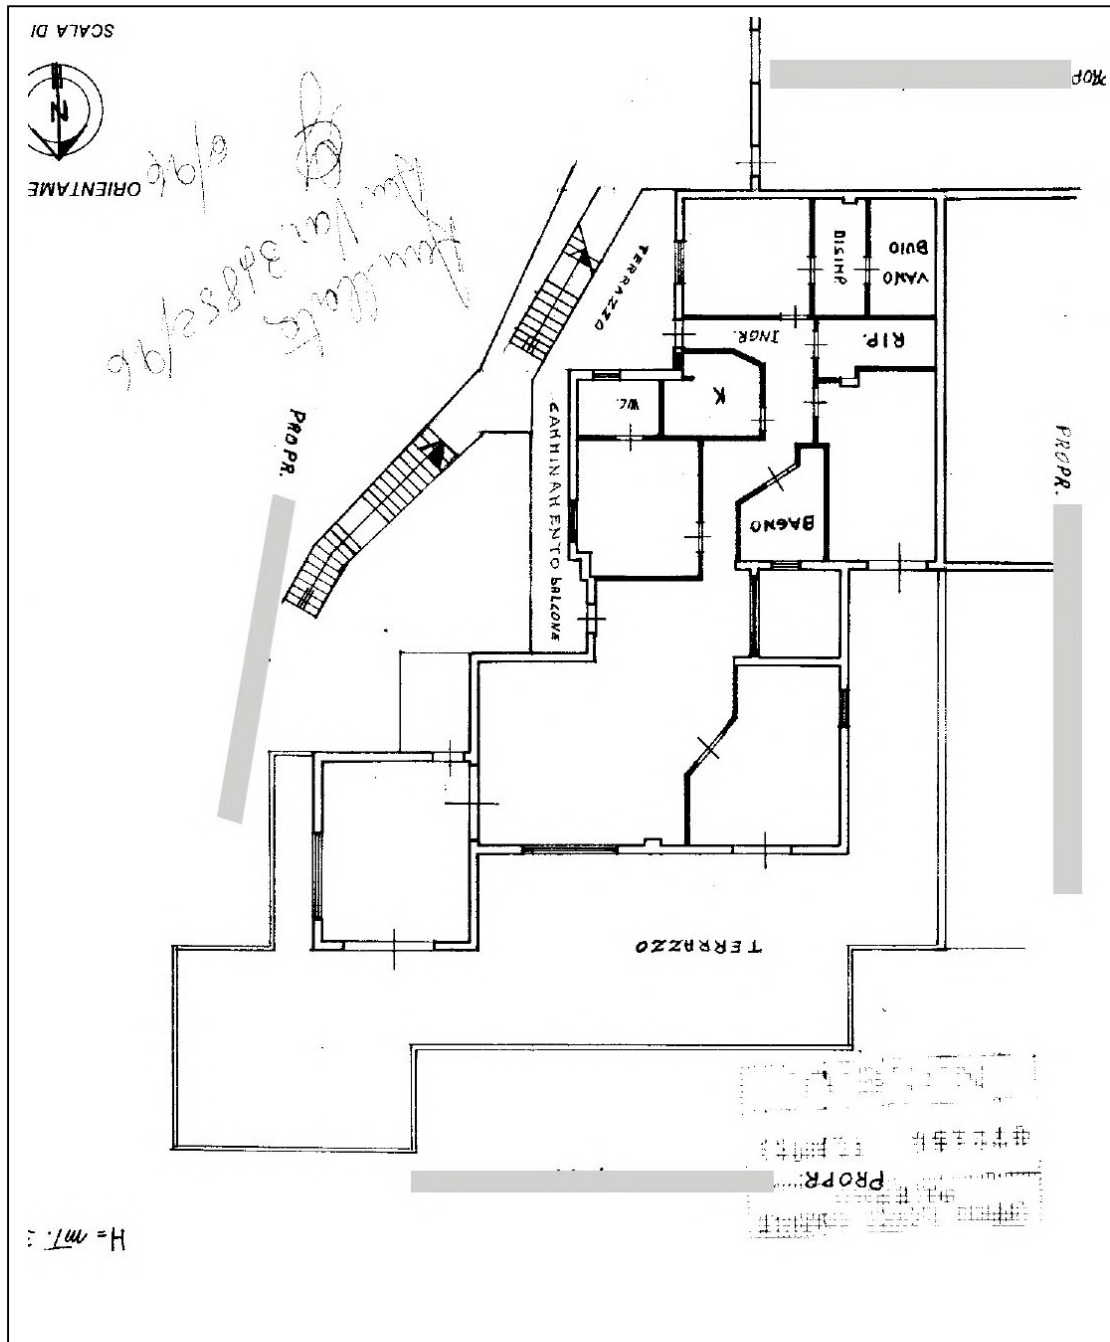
Estratto planimetria catastale del soppresso subalterno 37
